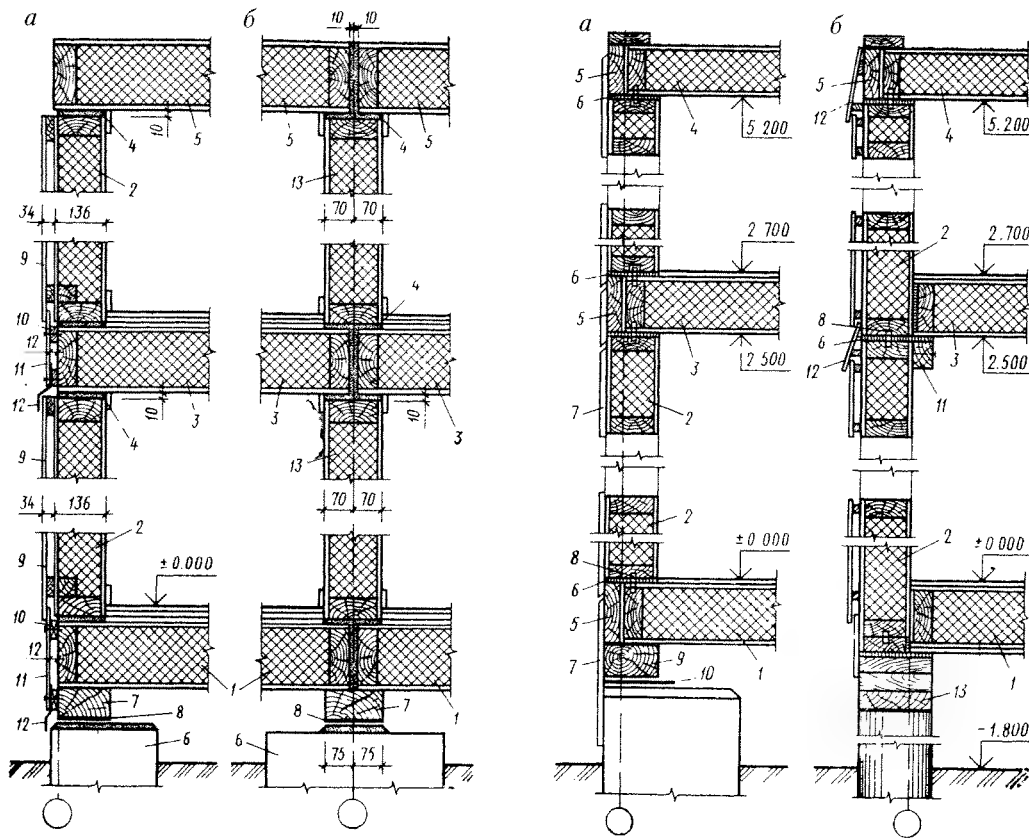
(слева). Конструкция горизонтального шва клефанерных панелей наружных и внутренних стен:
